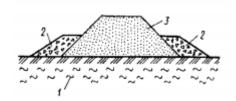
Увеличение устойчивости насыпи на слабых грунтах методом боковой пригрузки: 1 – слабый грунт; 2 – боковая пригрузка; 3 – насыпь
